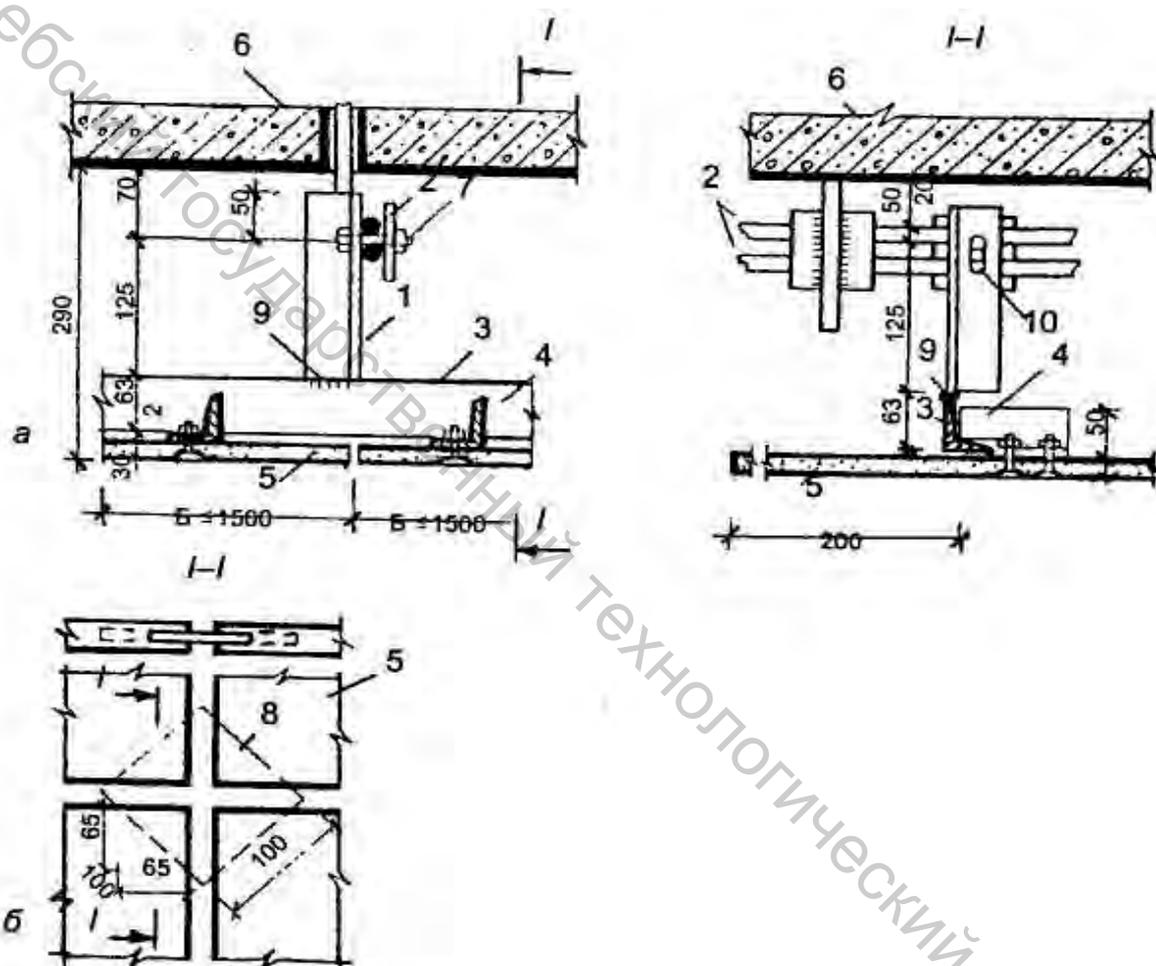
Подвесной потолок с креплением плит с помощью крепежных уголков:
